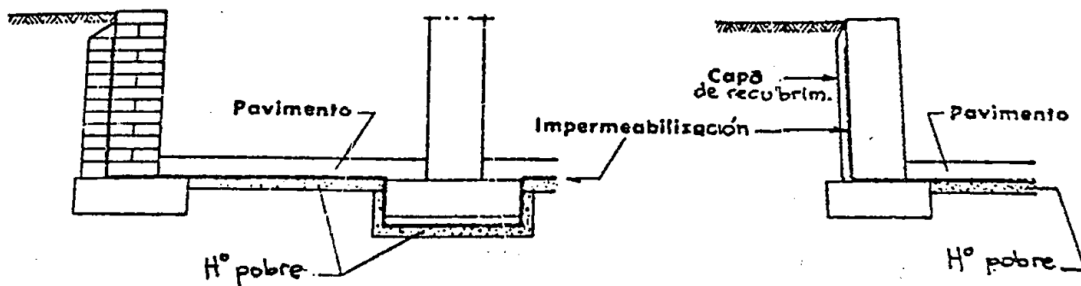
Composición típica en cimentaciones de estructuras enterradas.
